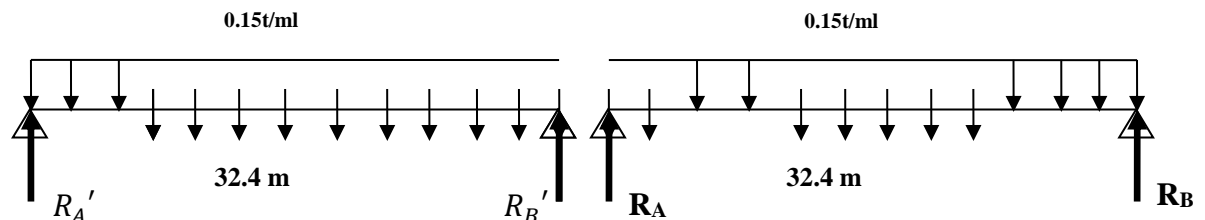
Disposition de la surcharge des trottoirs au niveau de la pile
